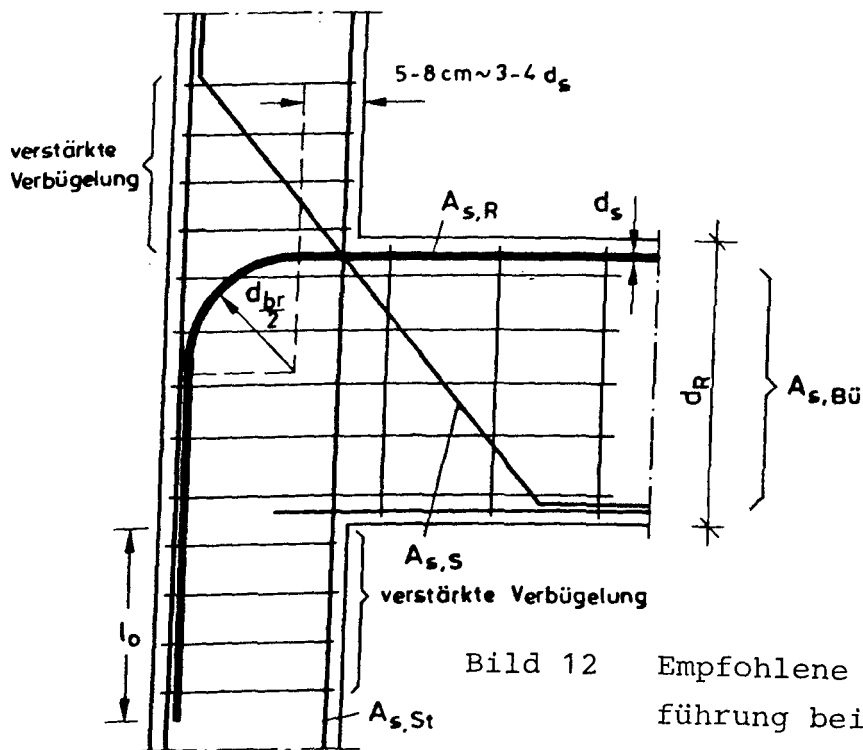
Empfohlene Bewehrungsführung bei abgebogener Riegelbewehrung
